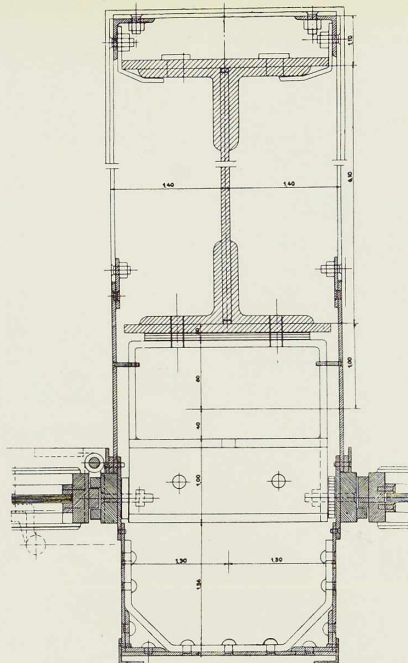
Coupe en travers d'un des poteaux de la façade. On notera le caisson en tôle recouvert de glace argentée.
